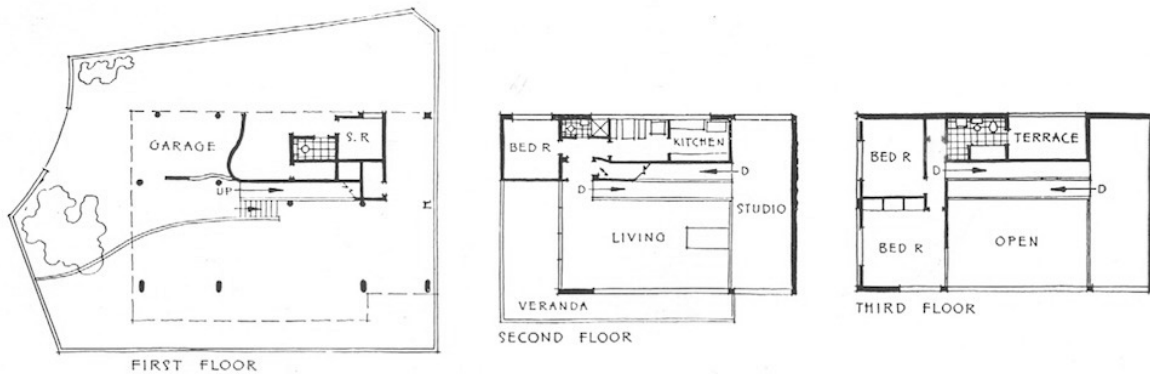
Plantas-baixas: primeiro, segundo e terceiro pavimento. Fonte: PAPADAKI, 1950.
